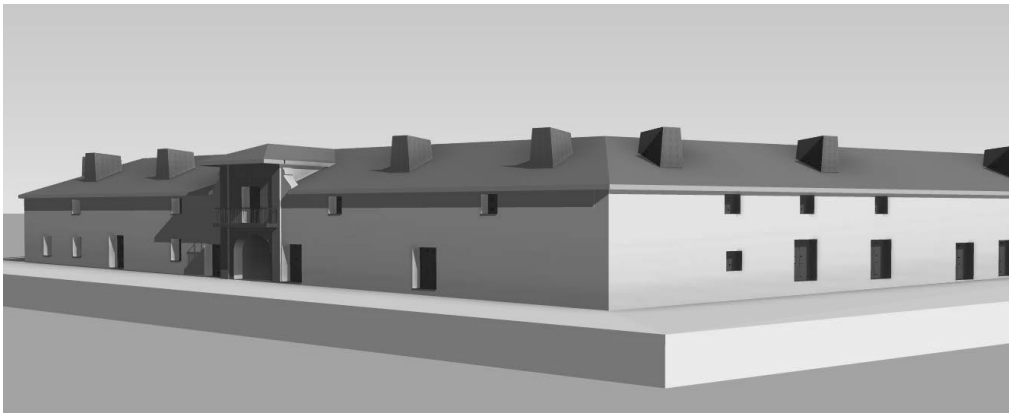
Vista esquina Calle Esparteros con Plaza Waldo Ferrer.
